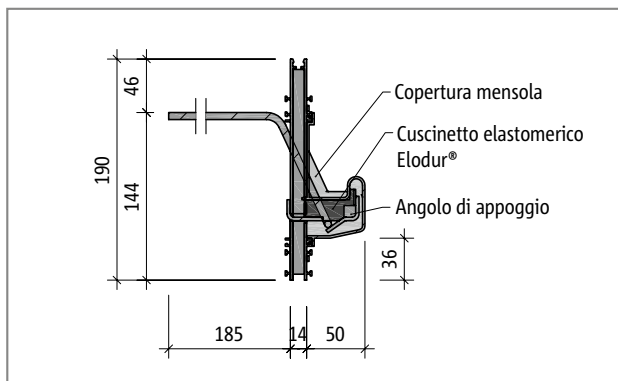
Schöck Tronsole® tipo T, sezione dell'elemento T...-H190 attraverso la mensola di supporto
